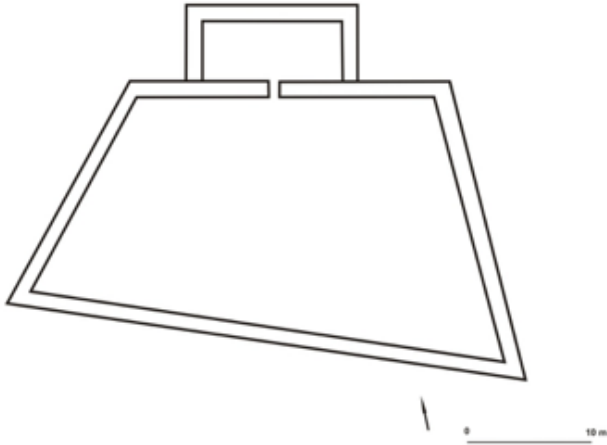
Croquis de planta de Castillejo de la Lapa (Valverde del Camino).
